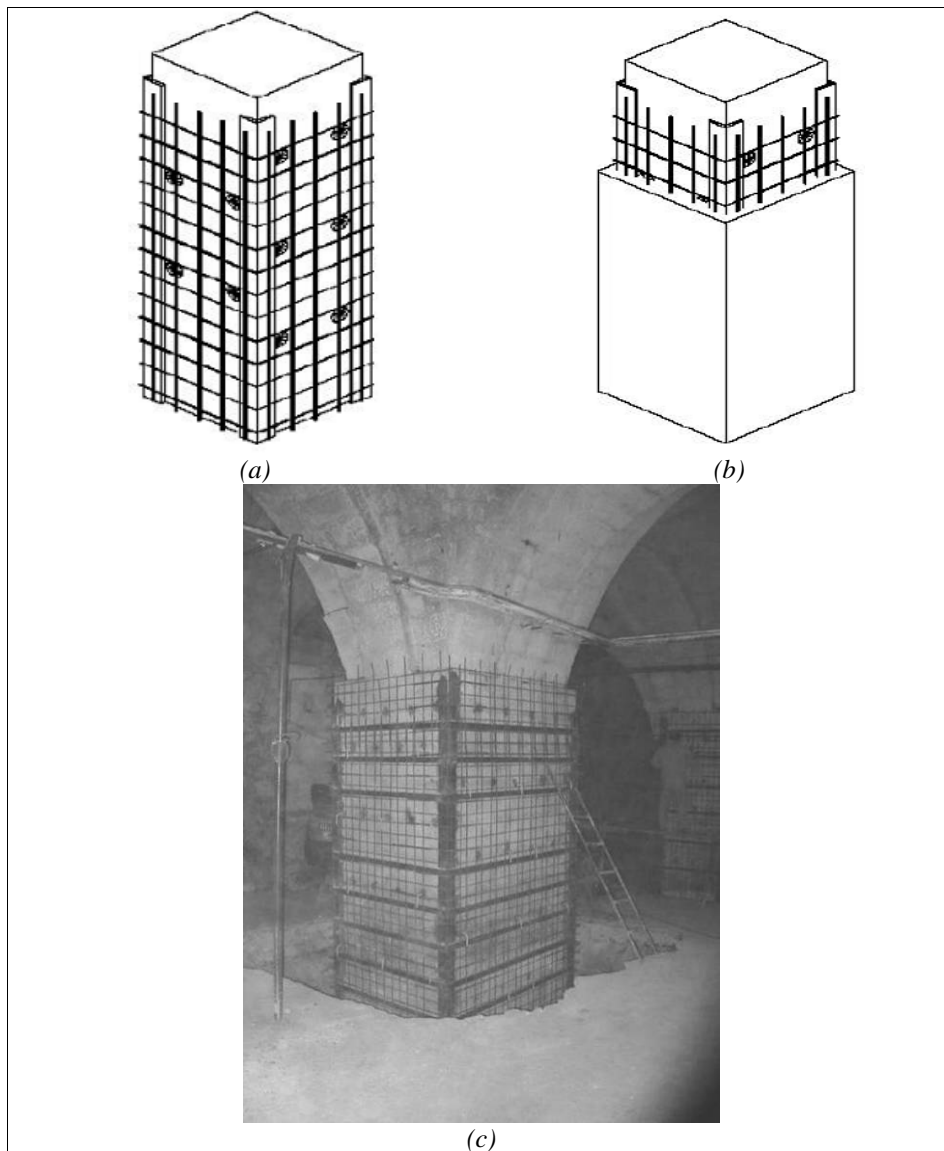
Consolidamento di un pilone in muratura con acciaio e betoncino armato (a) e (b) fasi dell'intervento (c) realizzazione dell'intervento [2.31].
